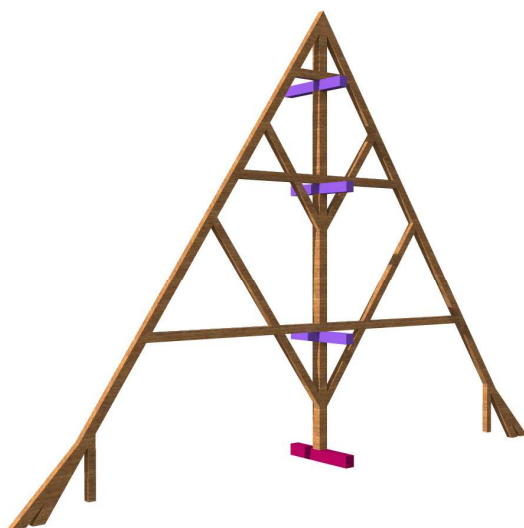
Schéma jednotlivých typů používaných krovových konstrukcí
